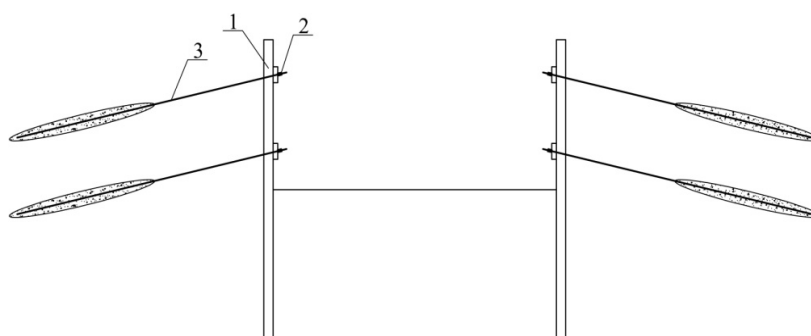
Крепление стен глубокого котлована грунтовыми анкерами: 1 – шпунтовое ограждение; 2 – крепление грунтового анкера к обвязке; 3 – грунтовые анкеры
